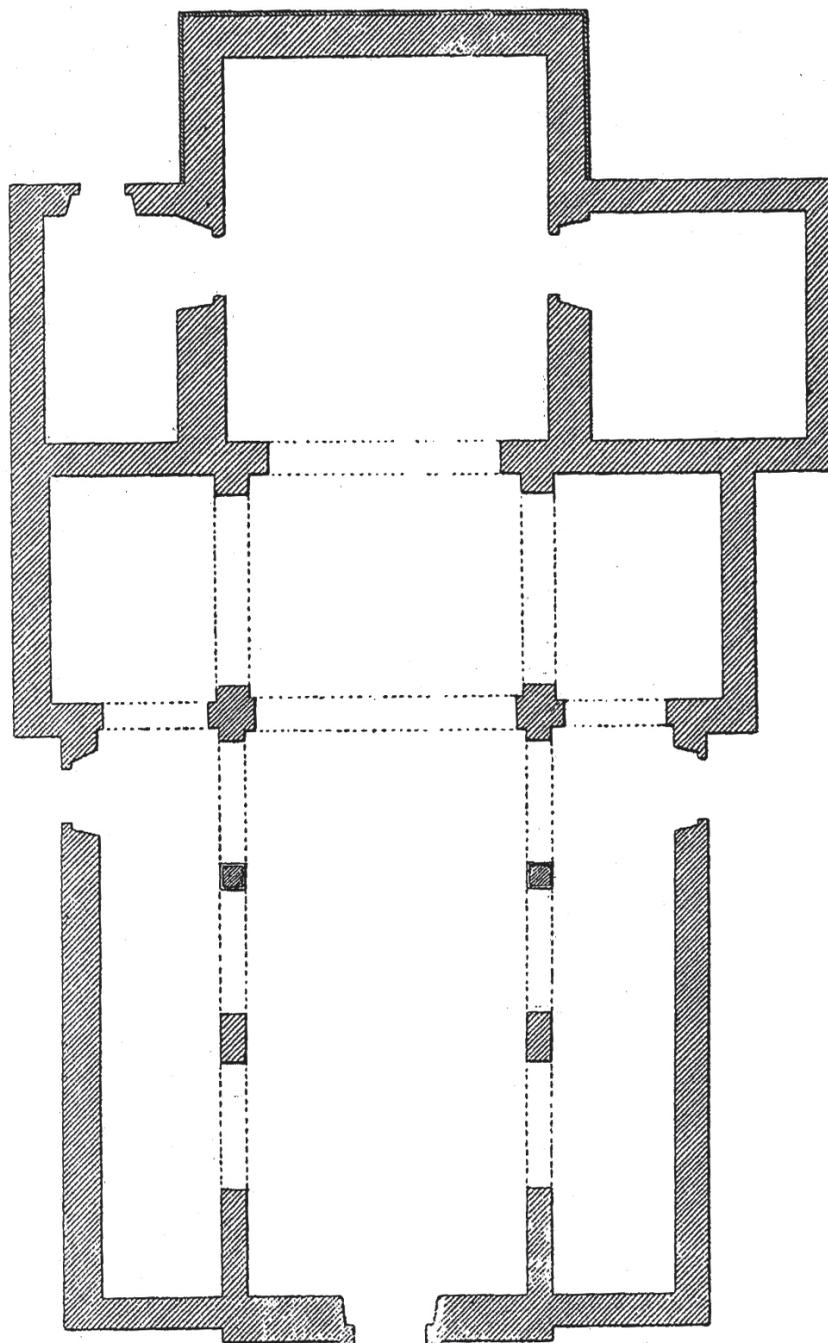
Pravia. Planta de la basílica *restaurada*. Estado actual según Selgas (1902: 8).
